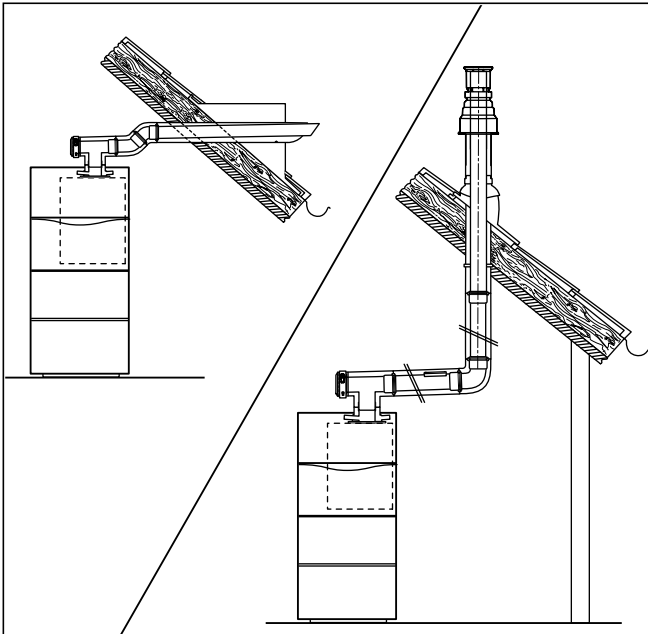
Conduite d'air/ de gaz d'échappement avec des accessoires Vaillant (exemples)
